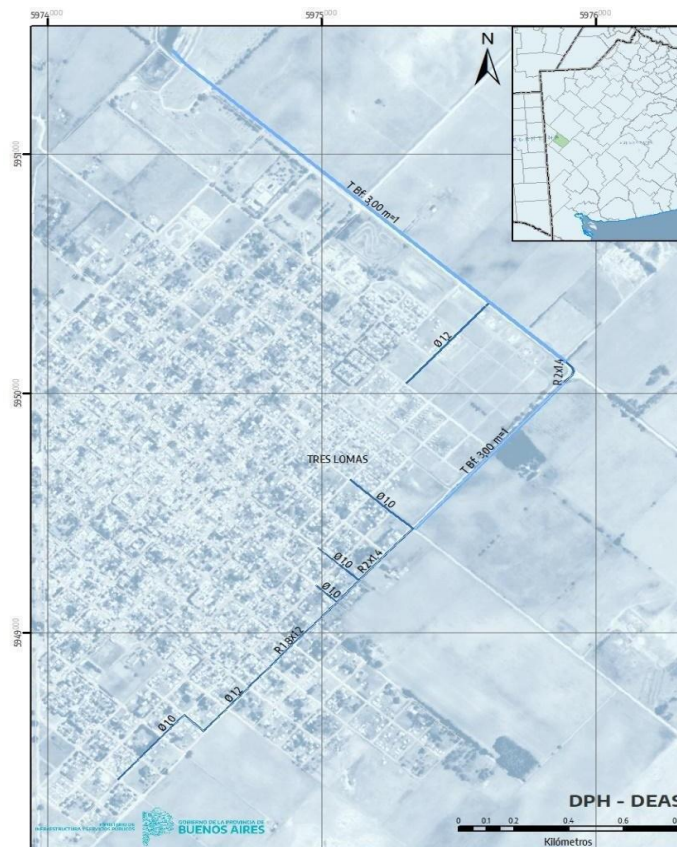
Planimetría de conductos y canal proyectado. Ver detalle en Anexo Planos. Fuente: DPH
